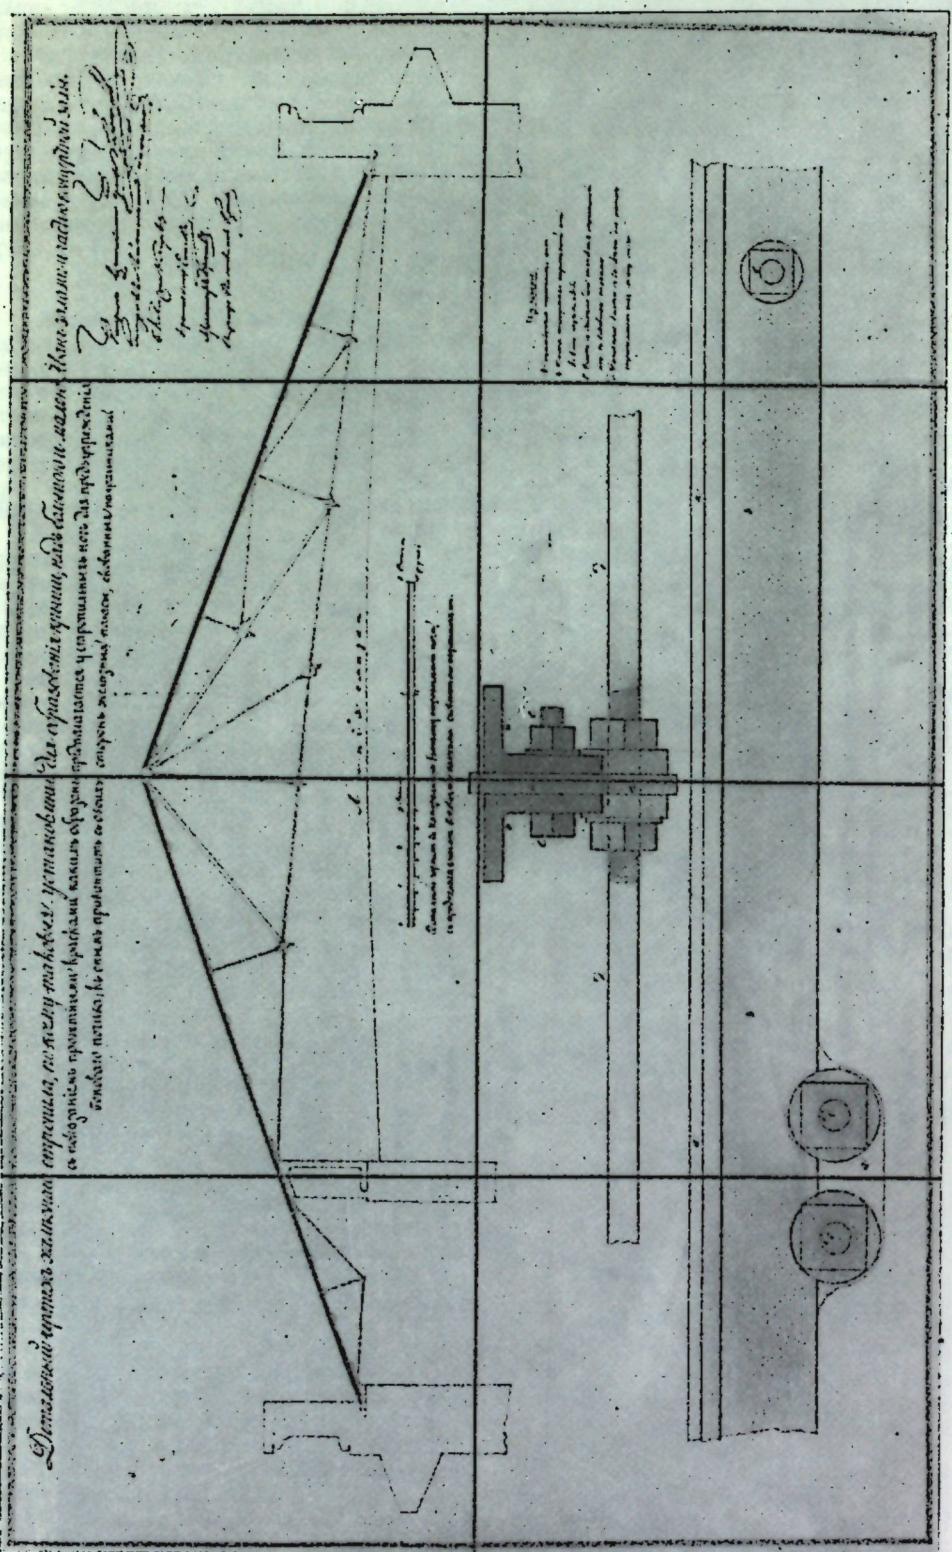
Чертеж усиления верхнего пояса стропил из угольниками
